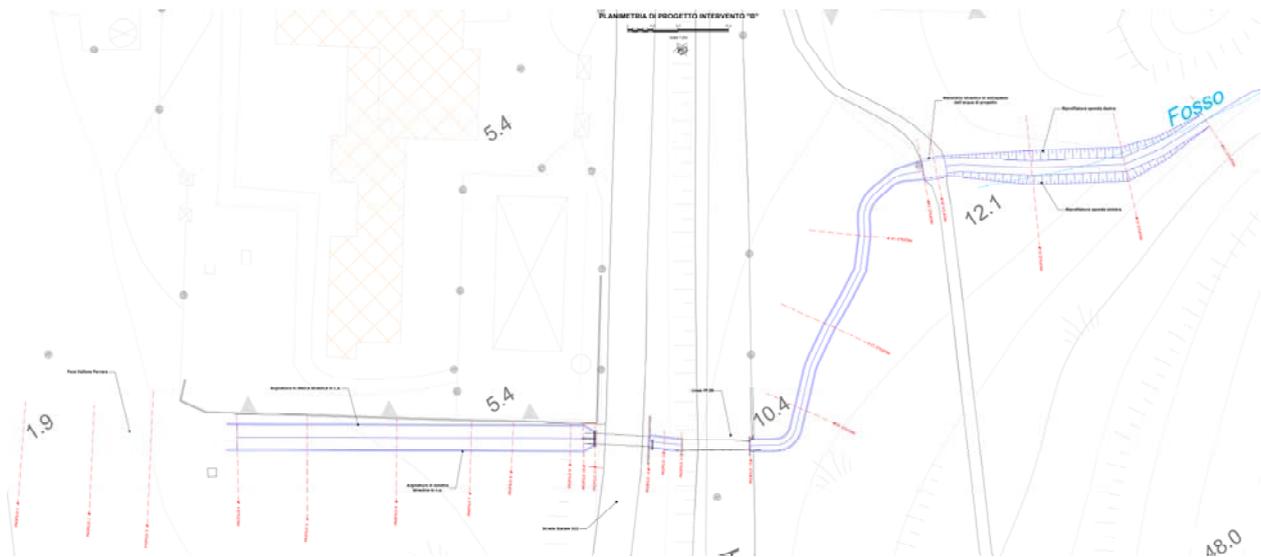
Planimetria generale dell'intervento "B" (lato mare a sx)
